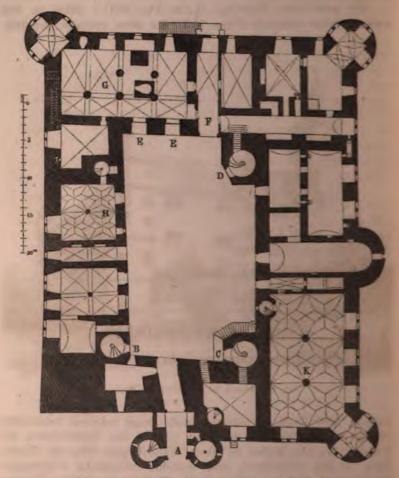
Schloss zu Neuenstein, Grundriss des Erdgeschosses.
